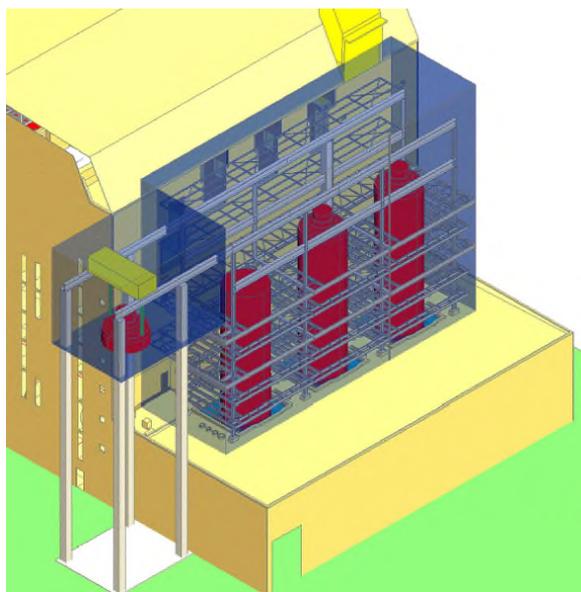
Struttura di confinamento e Sistema di sollevamento
